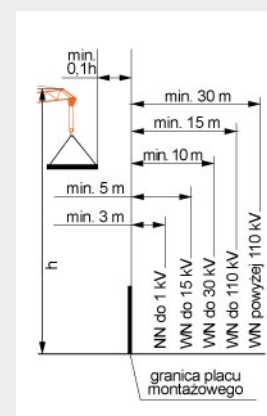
Strefa niebezpieczna przy montażu konstrukcji stalowych
